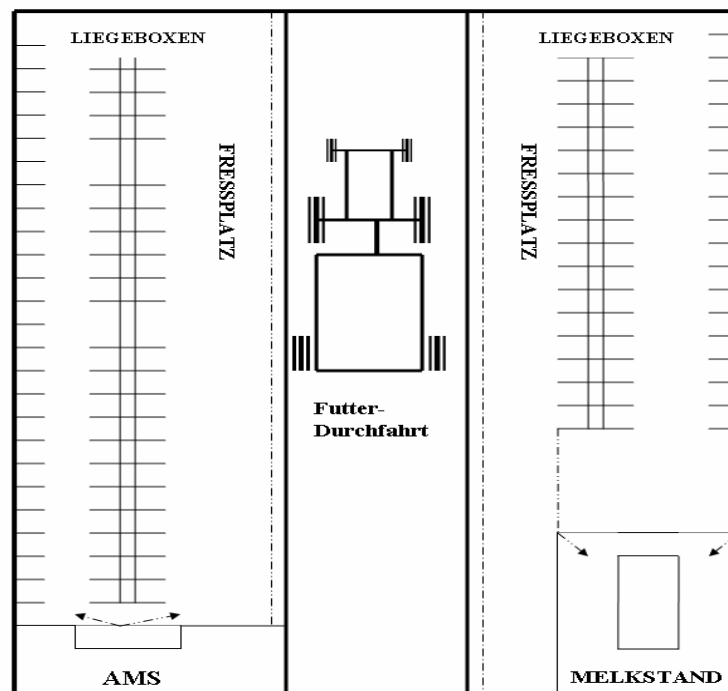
Grundriss- Schema der zwei Untersuchungsgruppen auf dem Eichhof
